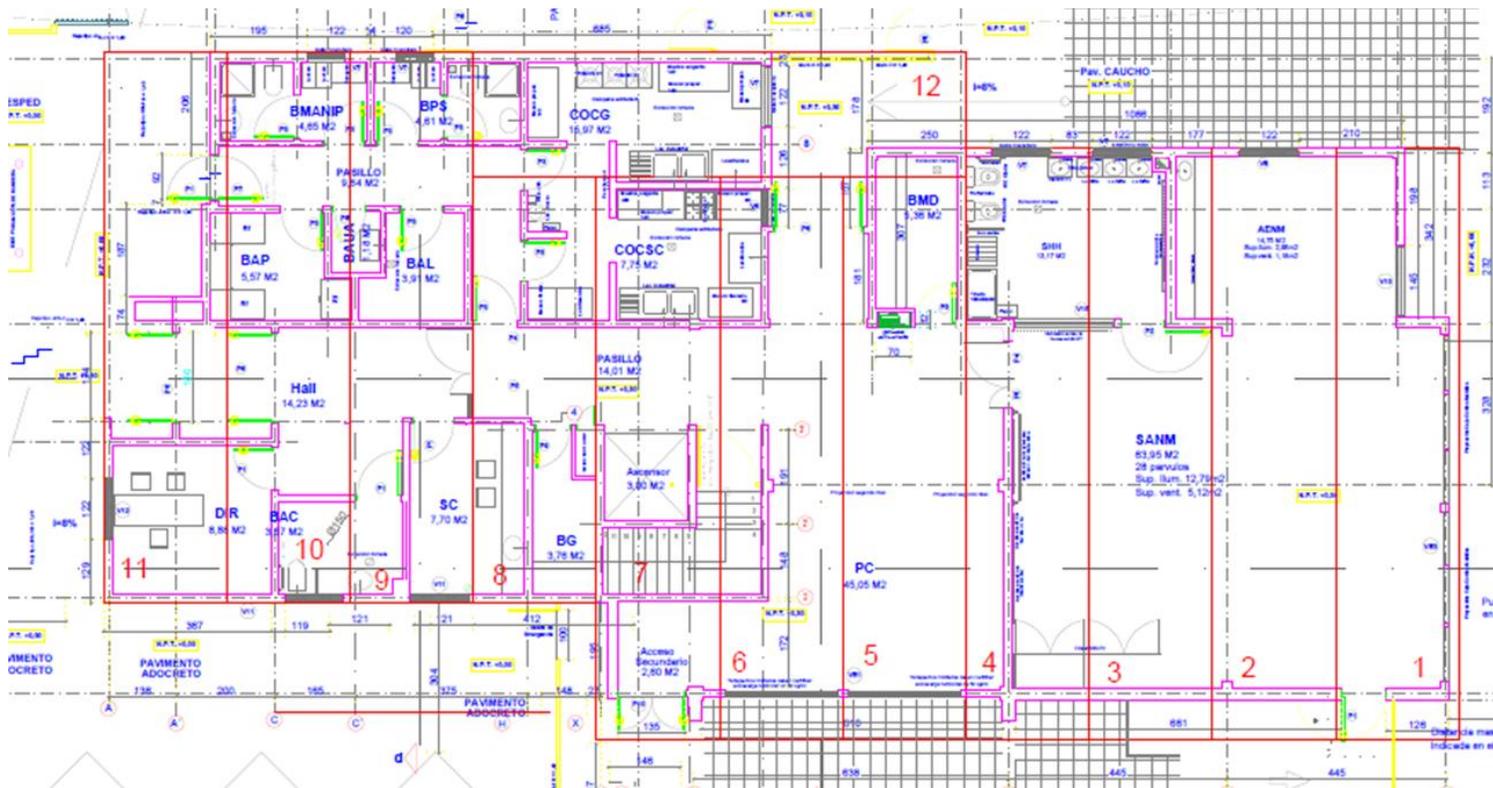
PLANTA PRIMER NIVEL ARQUITECTURA FRAGMENTADA. Fuente Elaboración propia.
